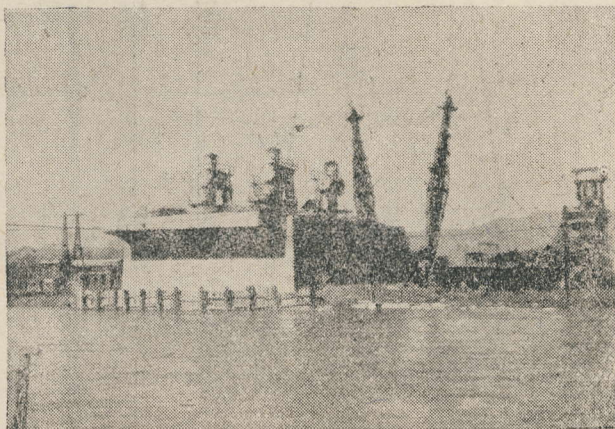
Betonirne kesone na lijevoj obali. Drveni tornjevi, kabske dizalice za transport materijala preko Save
